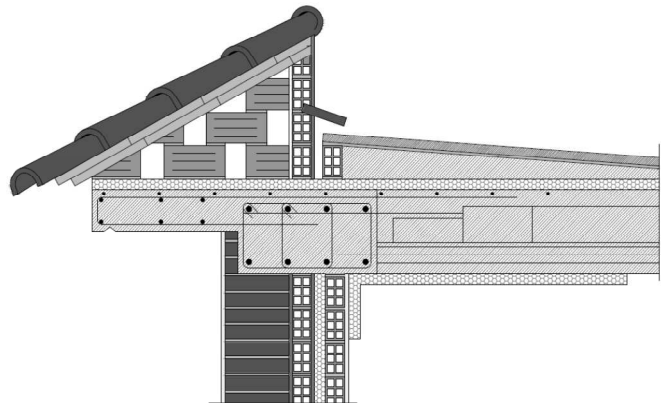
Fachada-Cubierta. Zona Oeste. Mejora.
